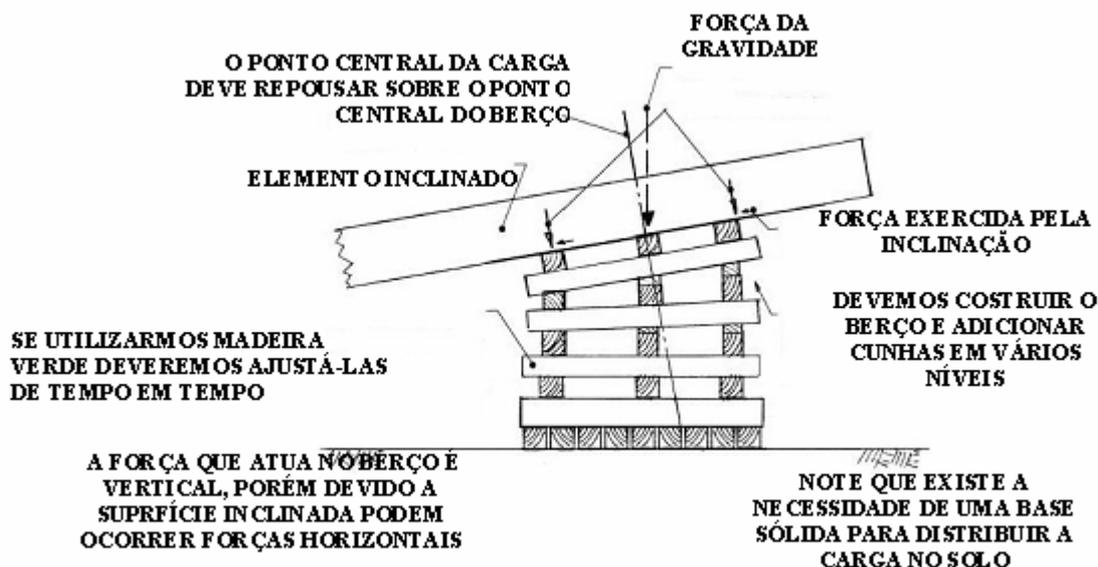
Escoramento vertical tipo berço de elemento inclinado
